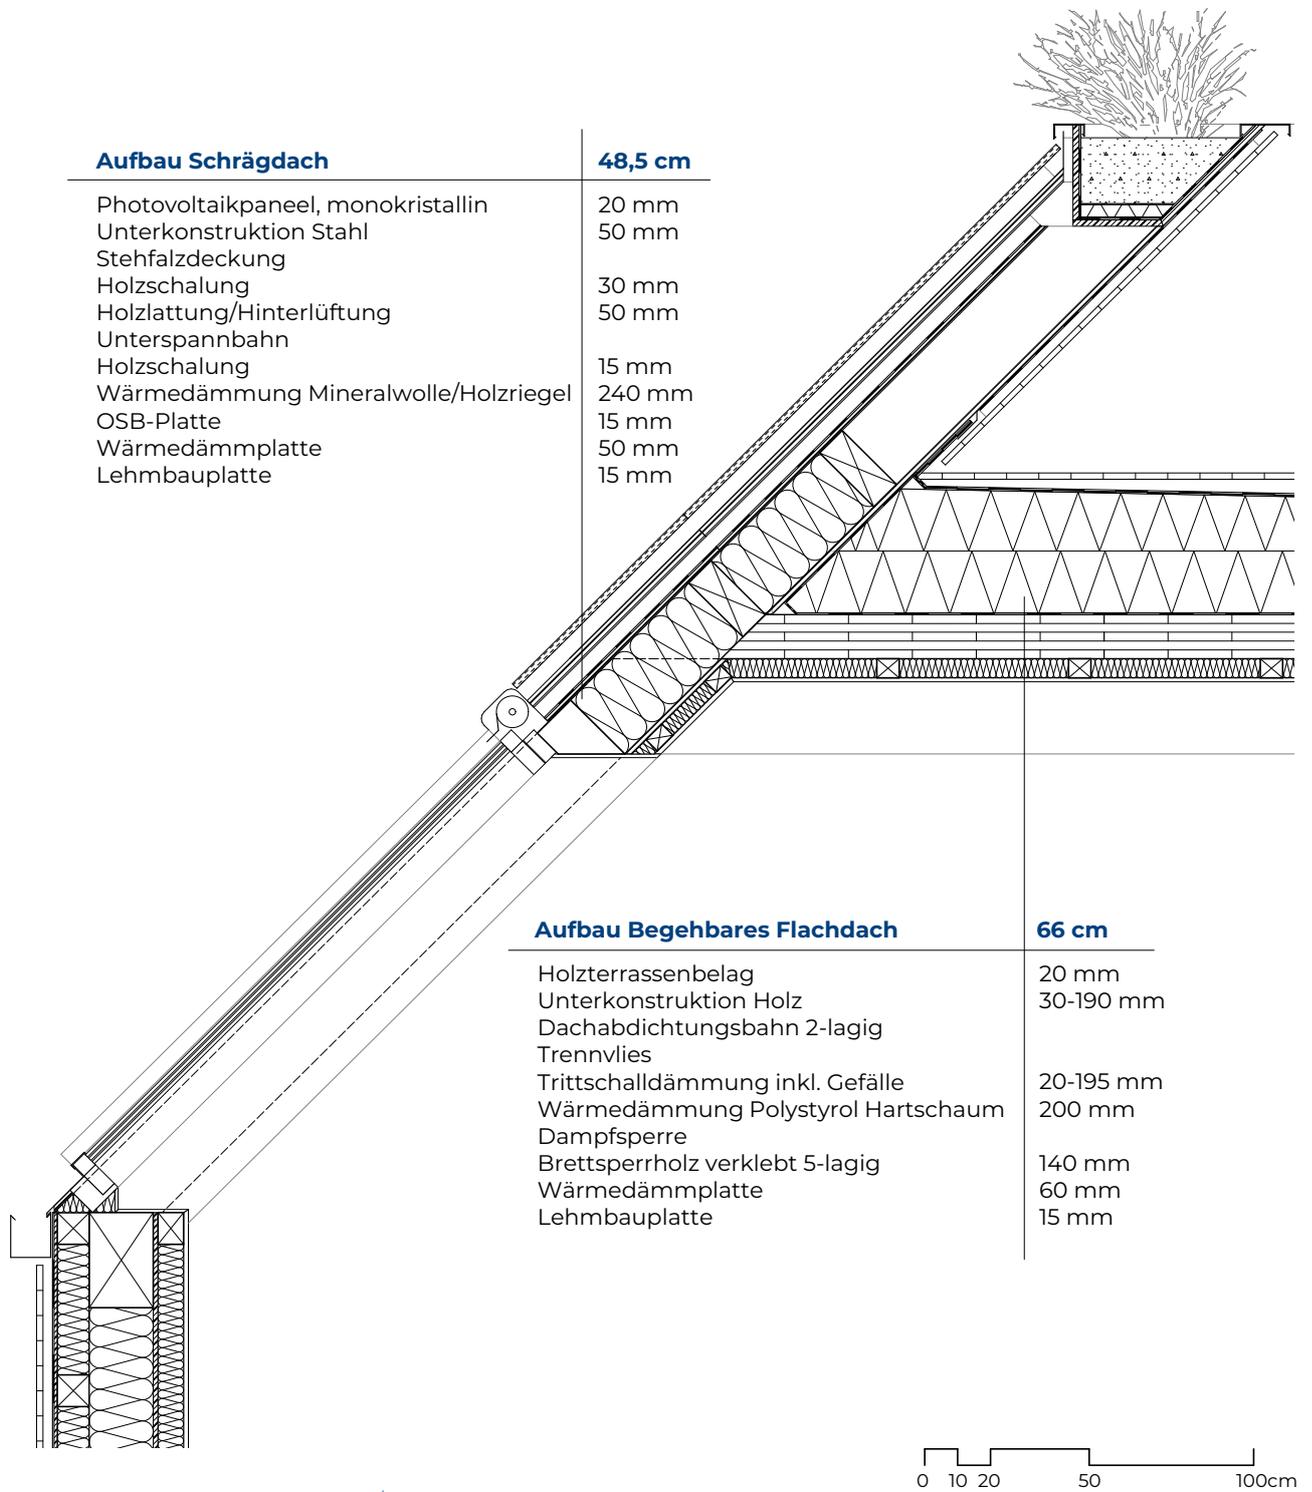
Konstruktionsdetail Geneigtes Dach/Flachdach (Eigene Darstellung)
